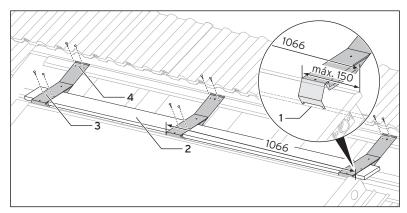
Colocar empalmes inferiores de la plancha del tejado (colector horizontal)
